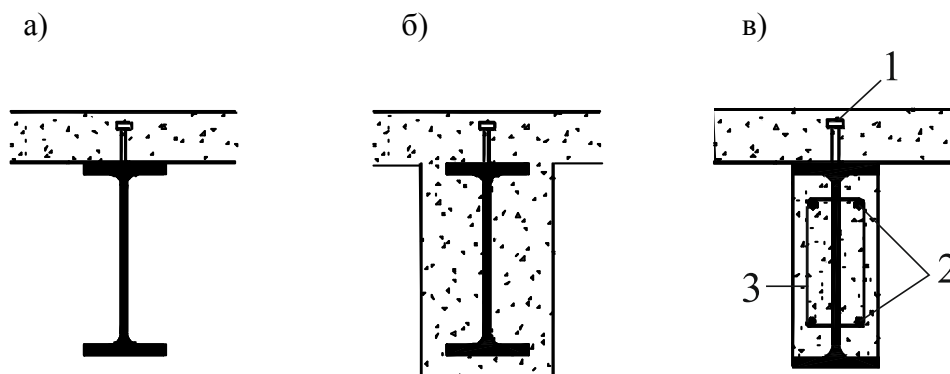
Методы повышения огнестойкости металлических балок сталежелезобетонных перекрытий при всестороннем нагреве (указано стрелками):
